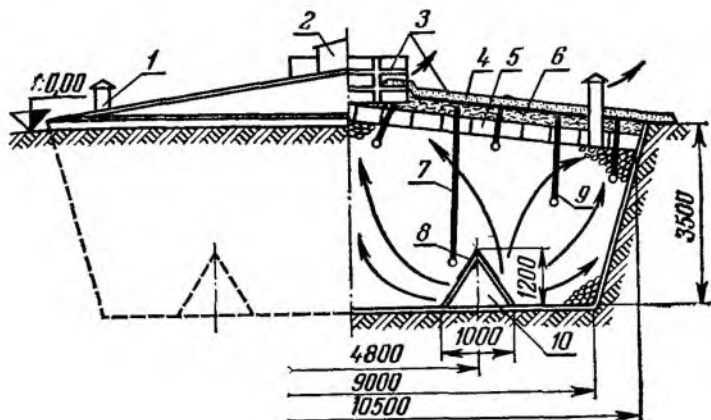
Схема хранения картофеля в силосной траншее (Эстонская ССР):
